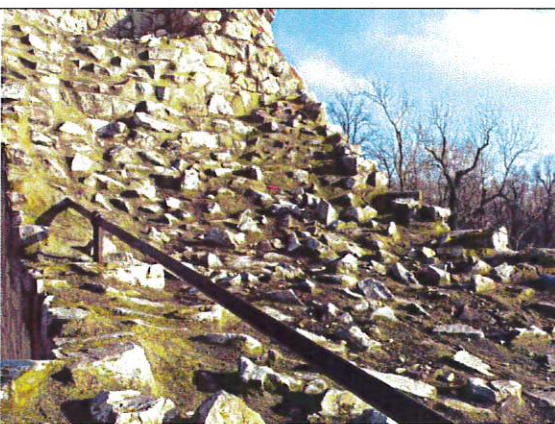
/B Widok muru sekcji od strony wewnętrznej - część od południa
